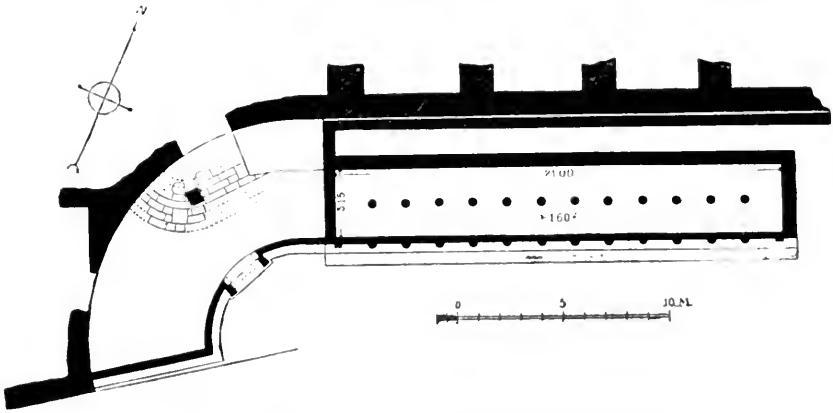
Grundriss des Brunnenhauses (Ergänzung).
